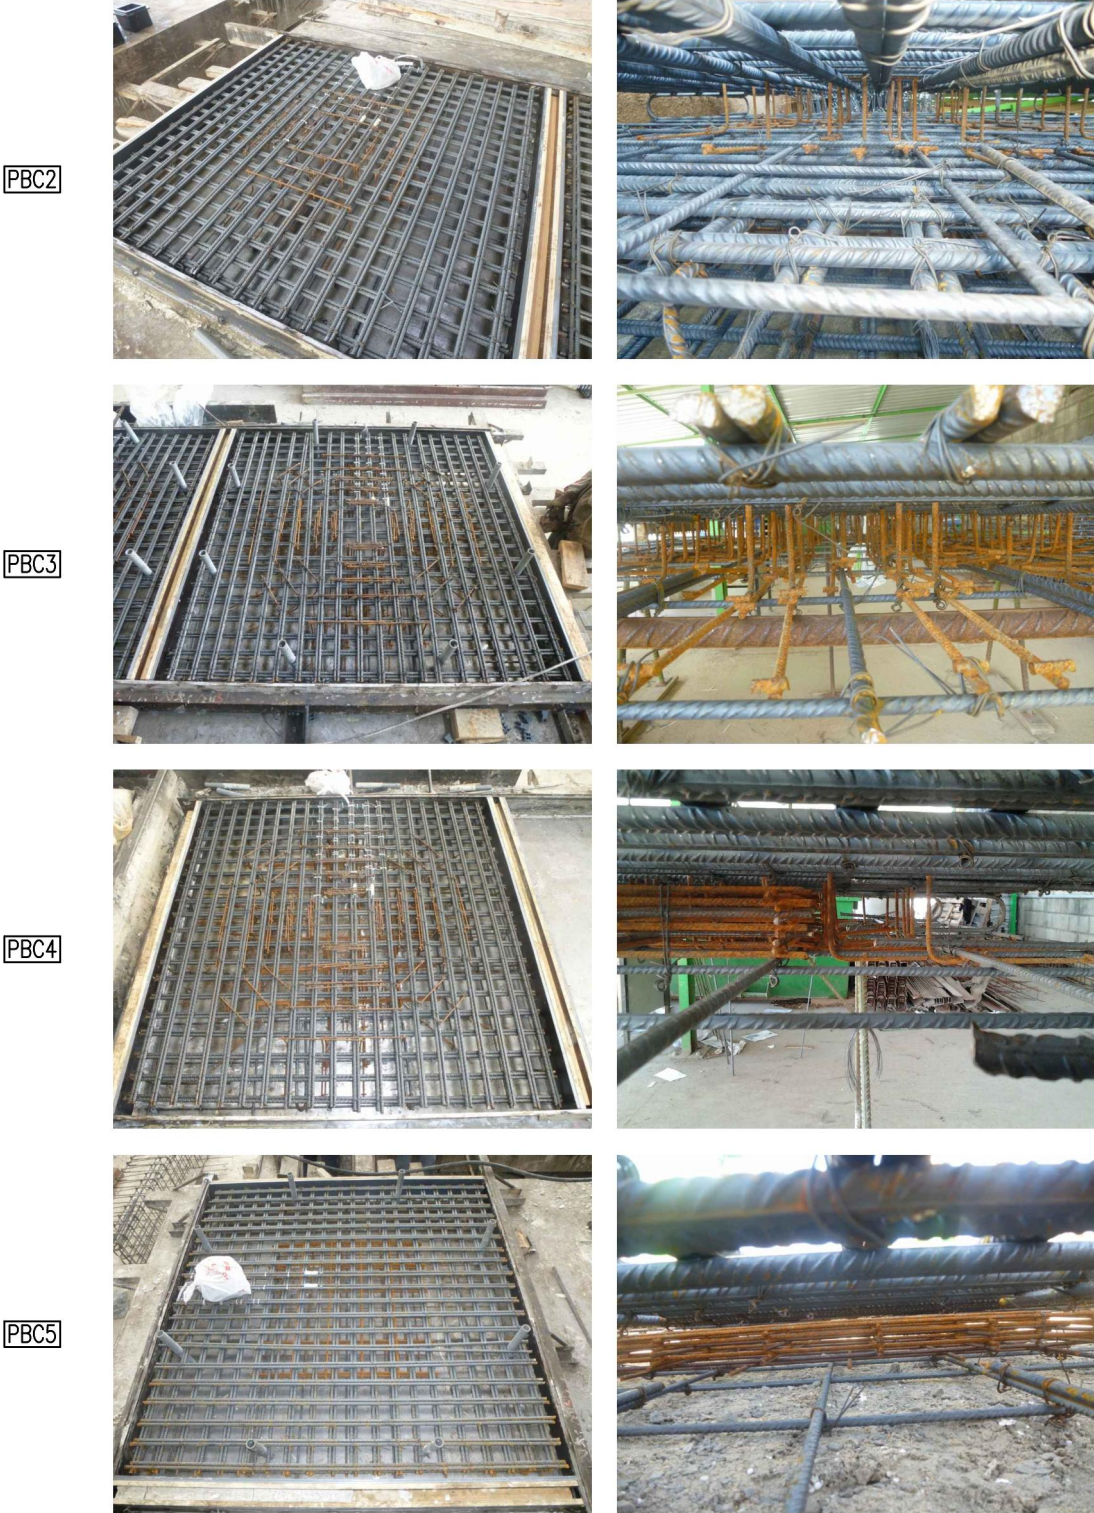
Fotografias do aspeto das armaduras antes da betonagem.
